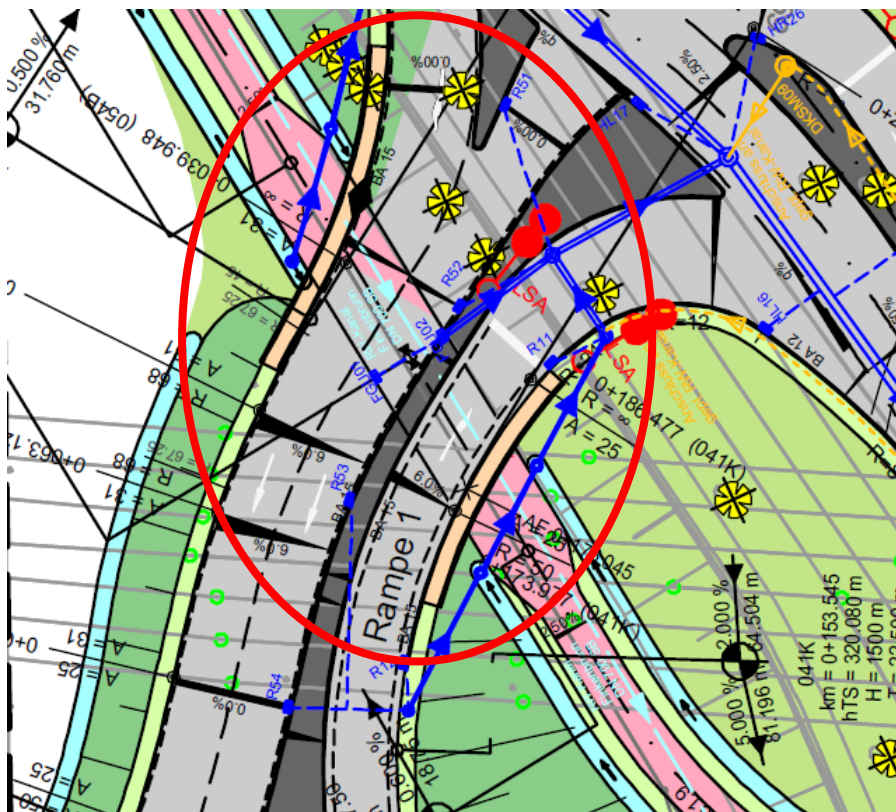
Lageplan - Bereich Unterführung BW 1.426
